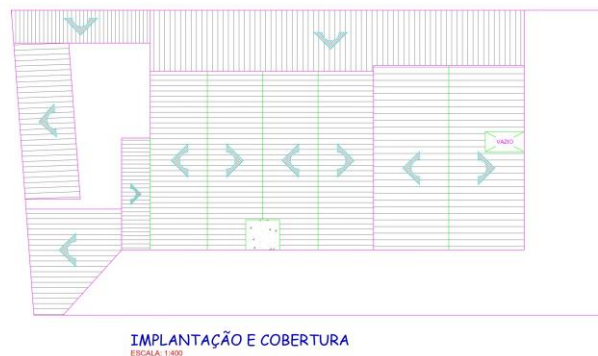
Implantação e cobertura. Fonte: Próprios autores
